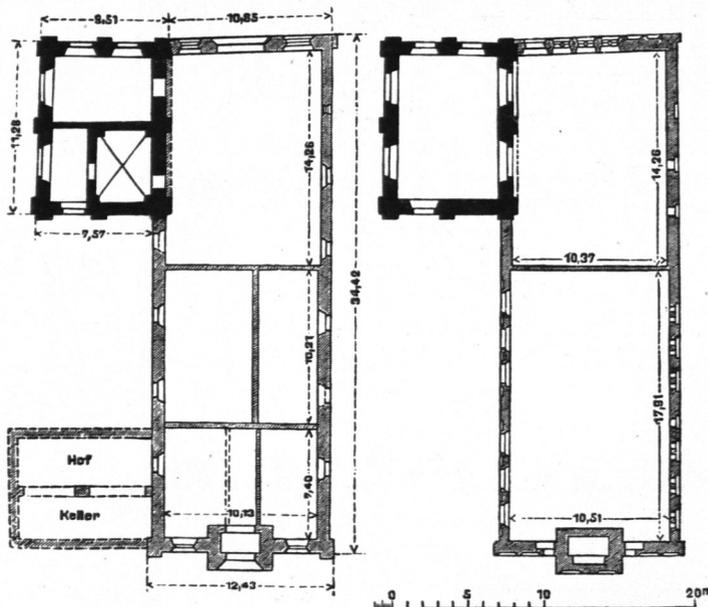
Rathaus zu Brandenburg a. S. (Altstadt). Grundriß nach Kolb. Denkmalspflege 1903.
